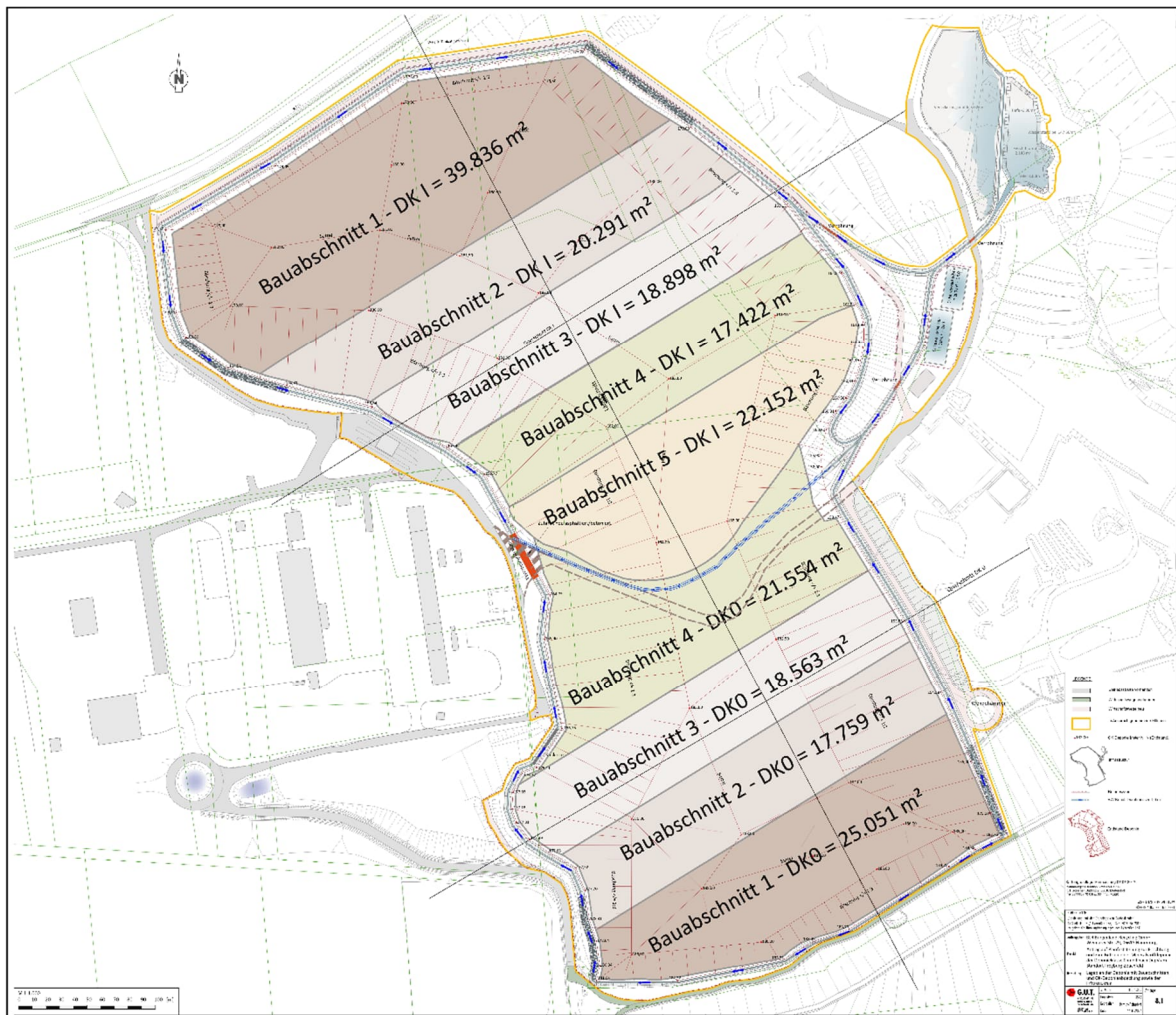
Lageplan der Deponie mit Bauabschnitten (Anlage 8.1)
